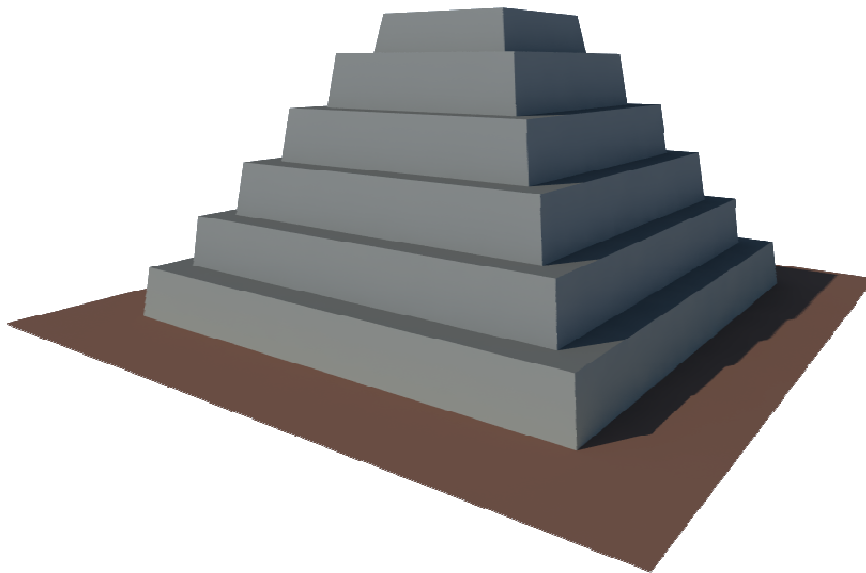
Fertig gestelltes Kernmauerwerk nach Rückbau der Rampen
